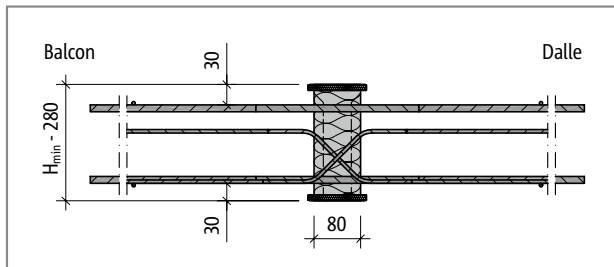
Schöck Isokorb® T Type D pour CV30 : Coupe du produit
